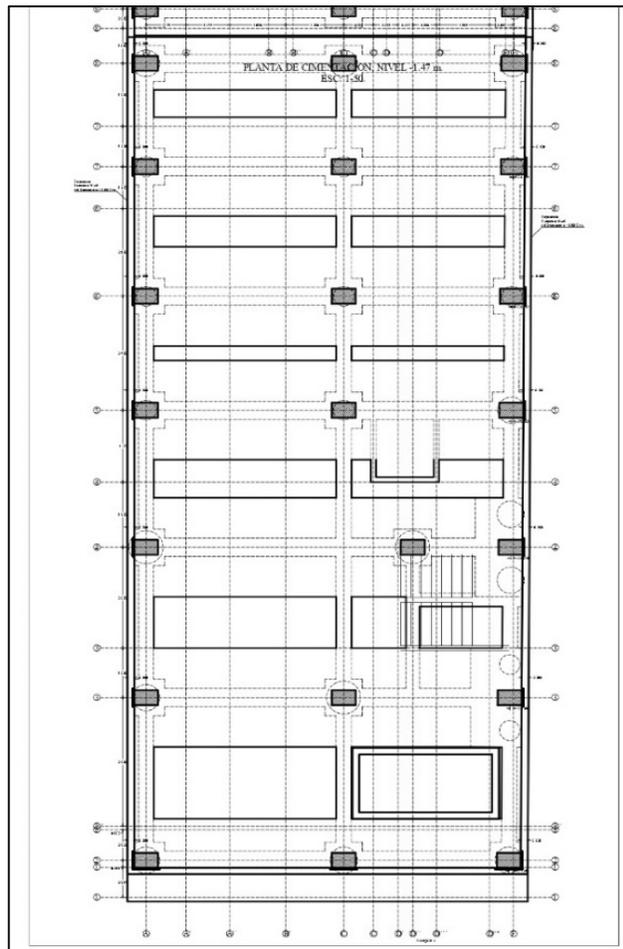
, cimentación nivel -1.47 bloque 1, fuente constructora Open House.
